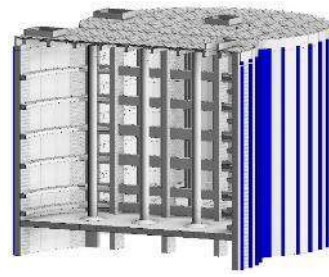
Corte transversal da estrutura do reservatório após execução da estrutura da cobertura.
